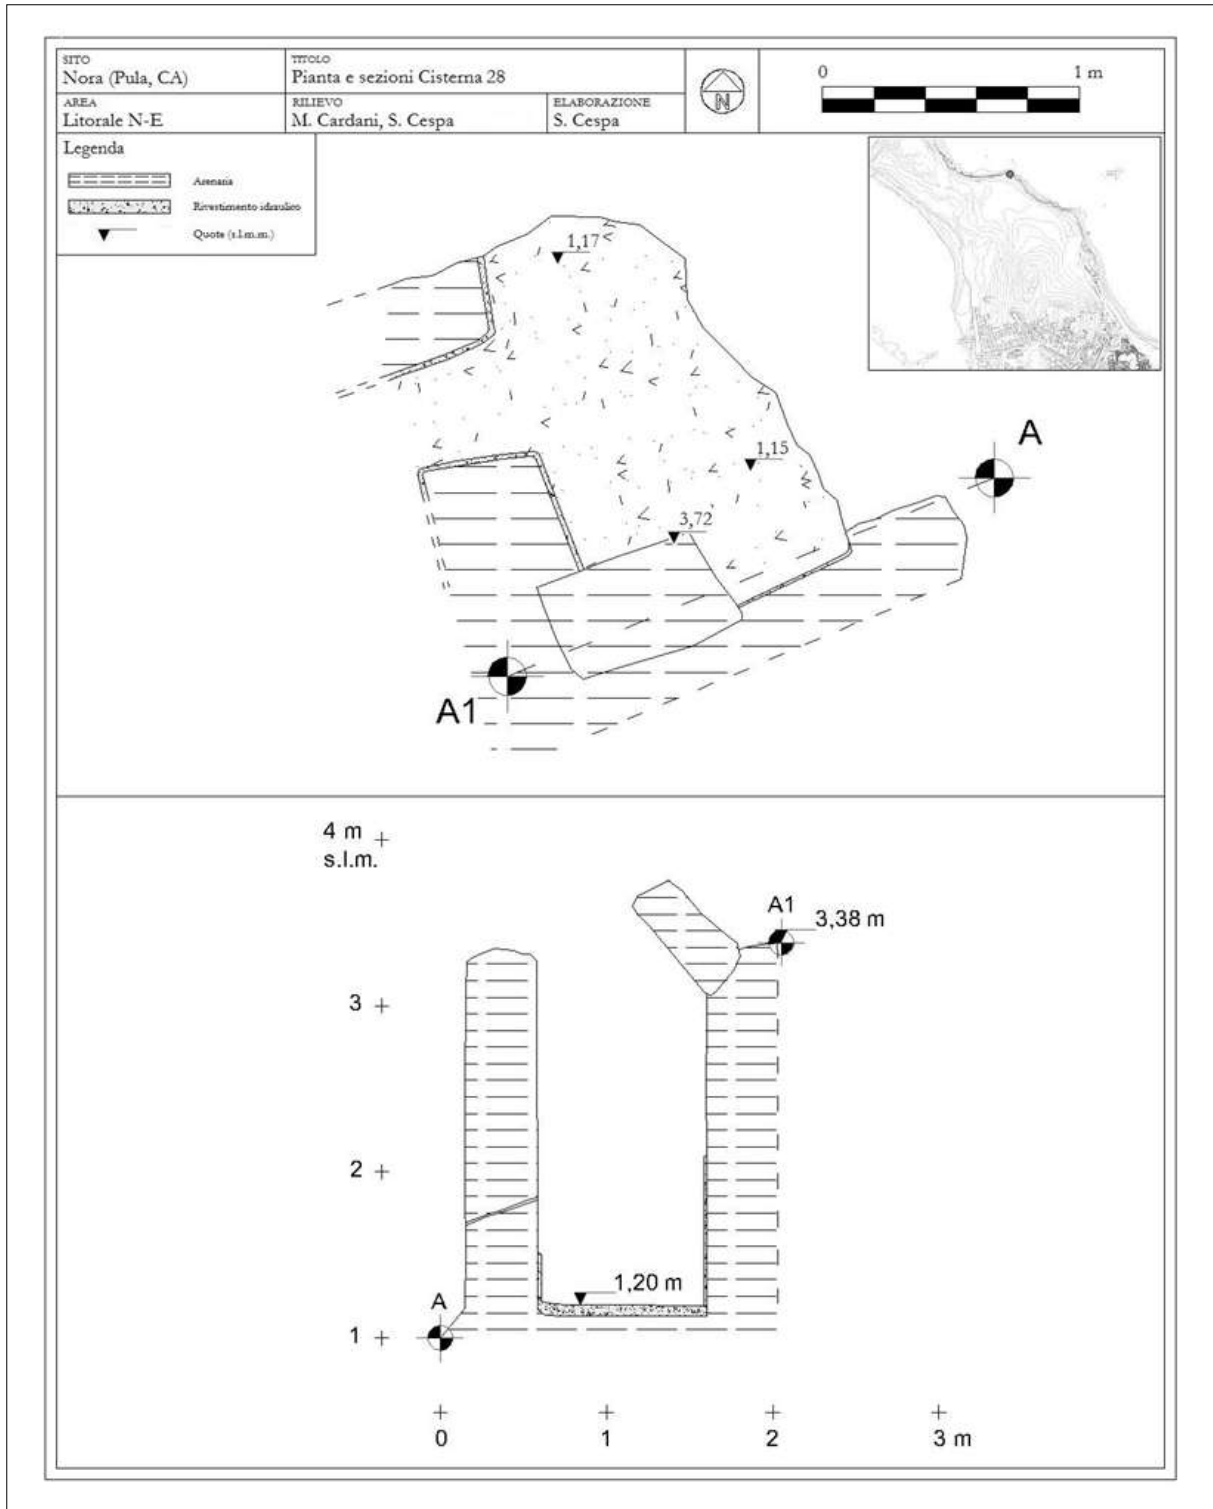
Pianta e sezione della cisterna 28 (elaborazione dell'autore).
